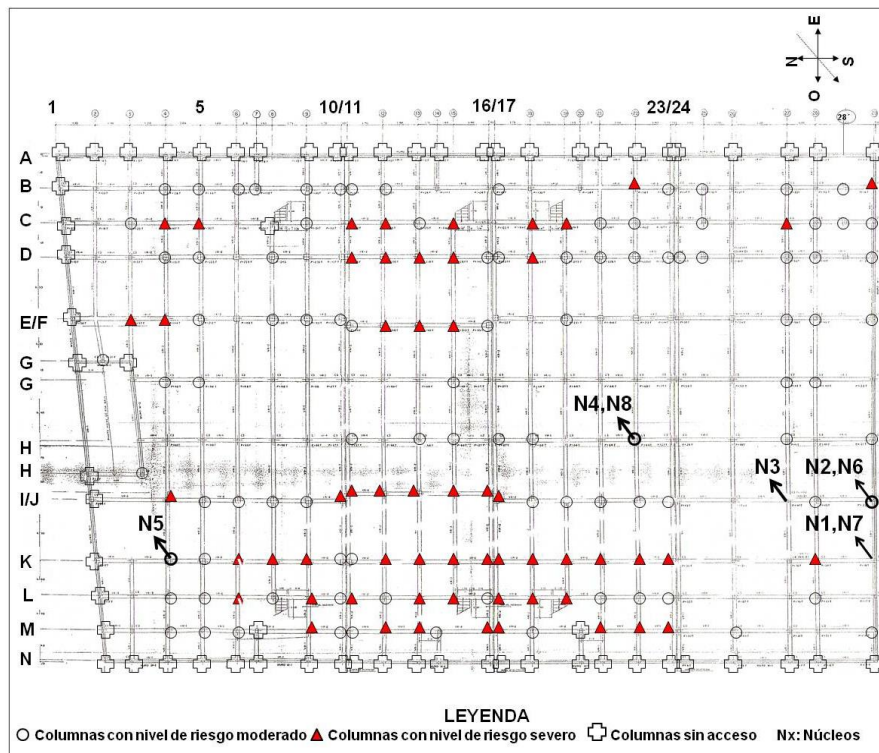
Plano de distribución de las columnas y localización de núcleos/testigos extraídos (N)
